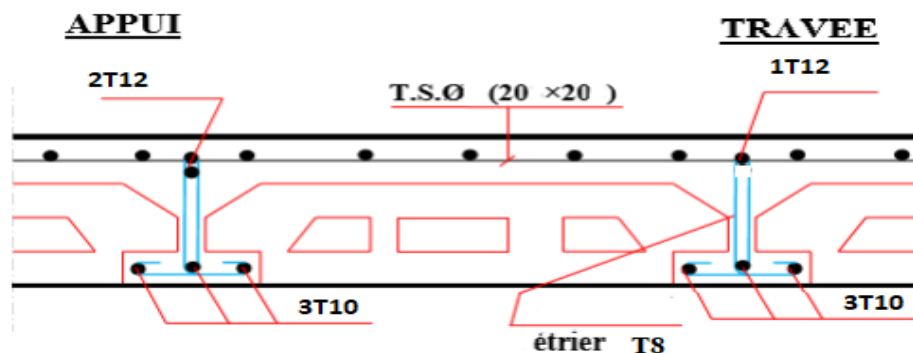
Schéma de ferrailage des planchers en appui et sur travée
